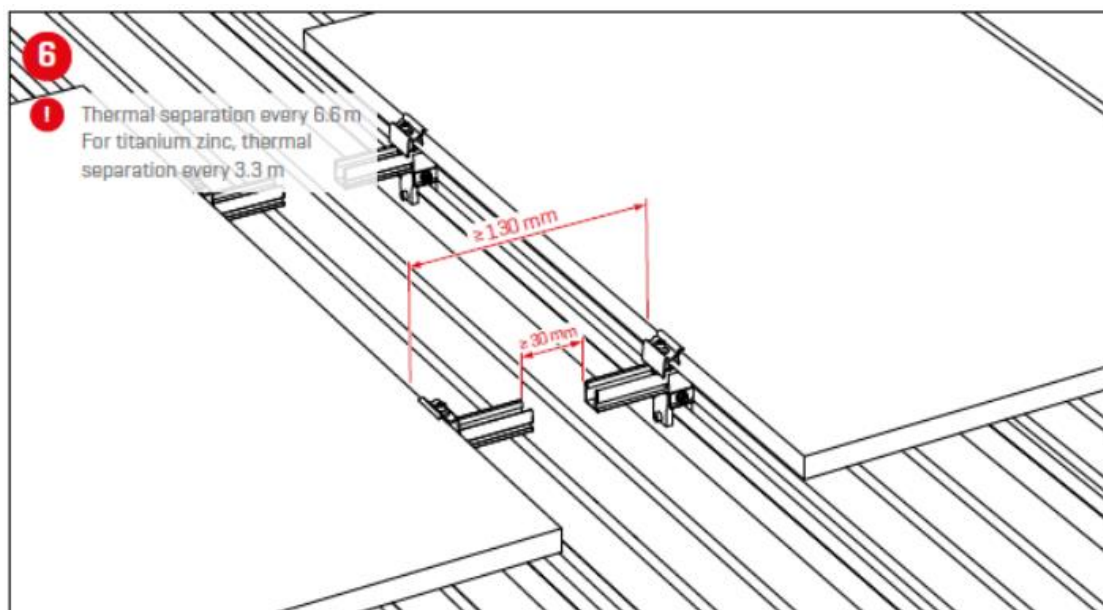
Passo 6 – Instalação da estrutura e módulos fotovoltaicos no telhado metálico
